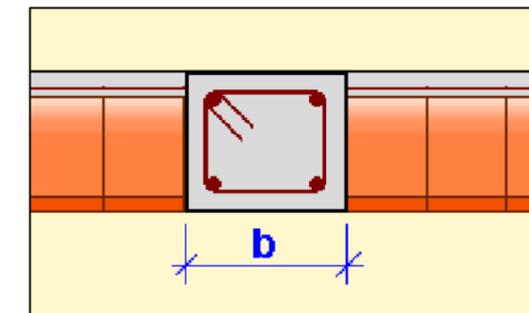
Captura imagen sección viga plana tipo. Fuente: CYPE
